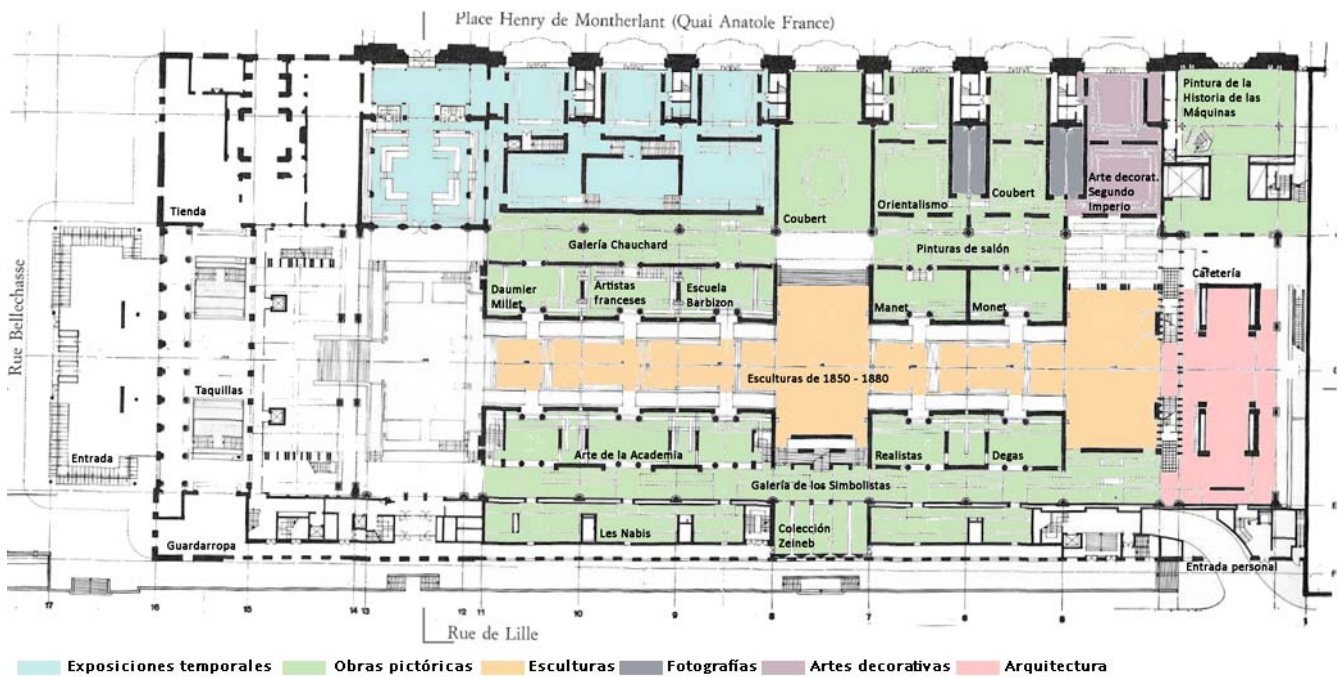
Planta baja con clasificación de salas según tipo de obras (Anexo 1)
